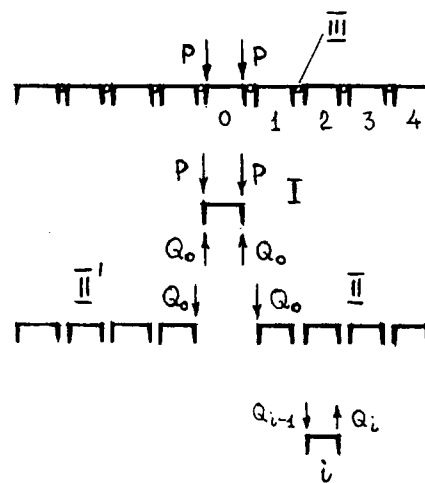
Поперечное сечение перекрытия, состоящего из ребристых плит и загруженного локальной нагрузкой а — расчетная схема (III — продольные линейные шарниры, аппроксимирующие работу замоноличенных стыков); б — разложение перекрытия на три подсистемы (I, II и II'); в — вертикальные перерезывающие силы в смежных стыках элемента  $i$ ; 0, 1... 4 — номера плит в подсистемах I и II
